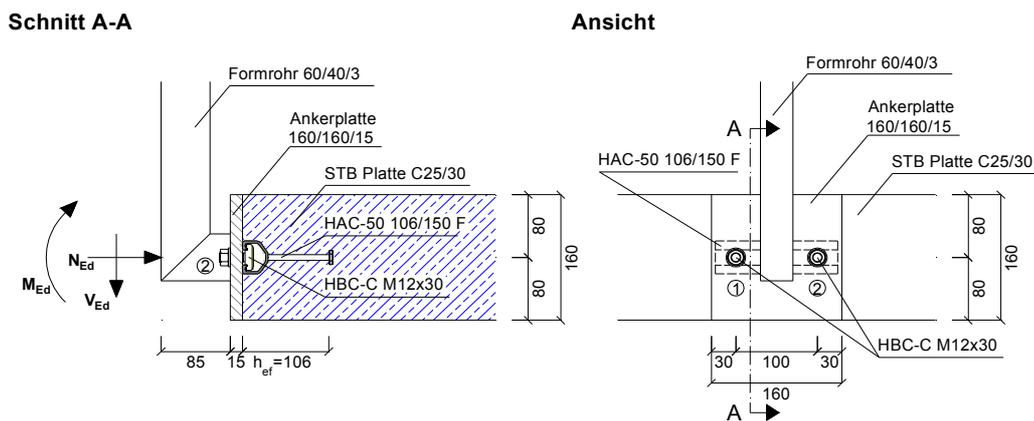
Anschlussdetail G2 Ankerschiene (Maße in mm)
